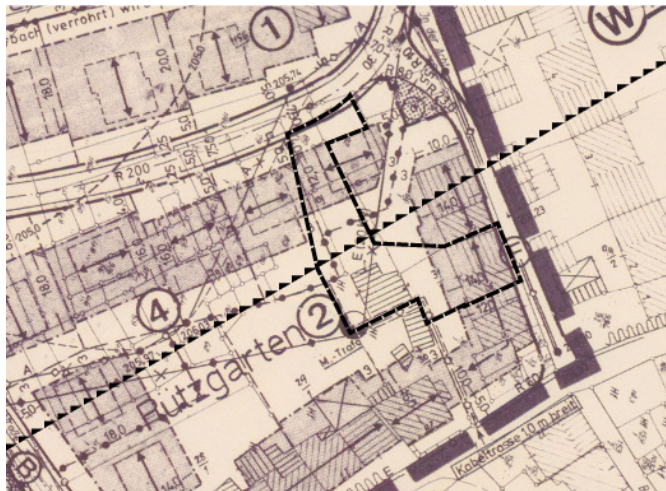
Bebauungsplan „In der Acht“ - Ausschnitt (VG SAARBURG 1992)
